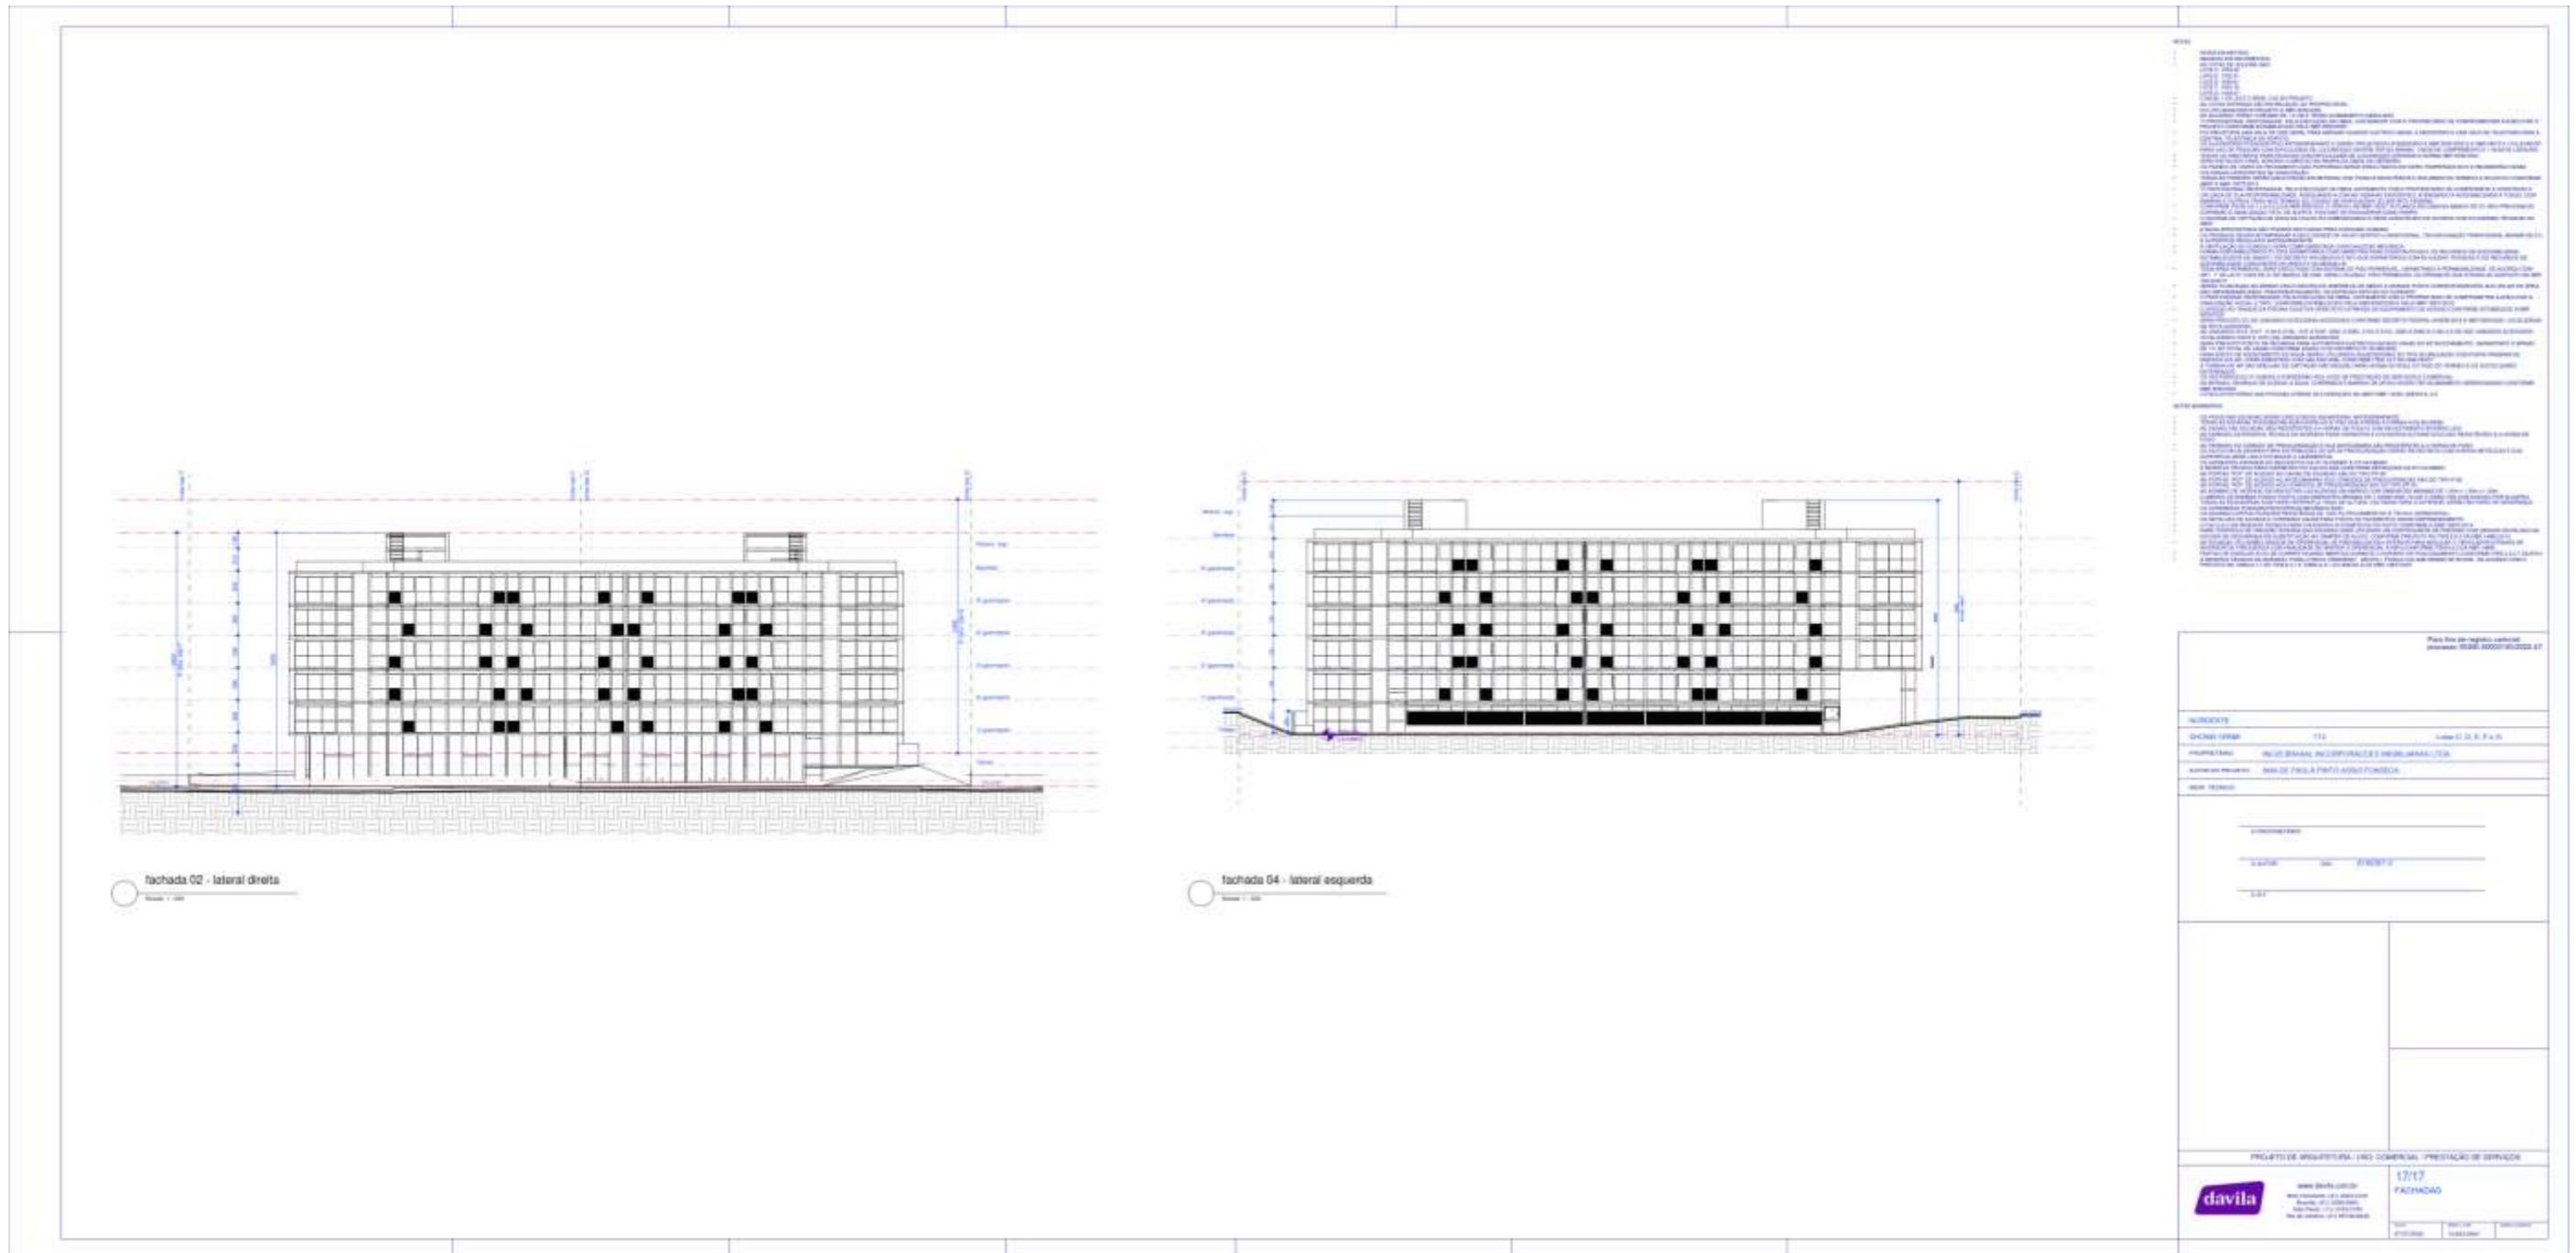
Fachadas. Fonte: Estudo Prévio, em anexo.
